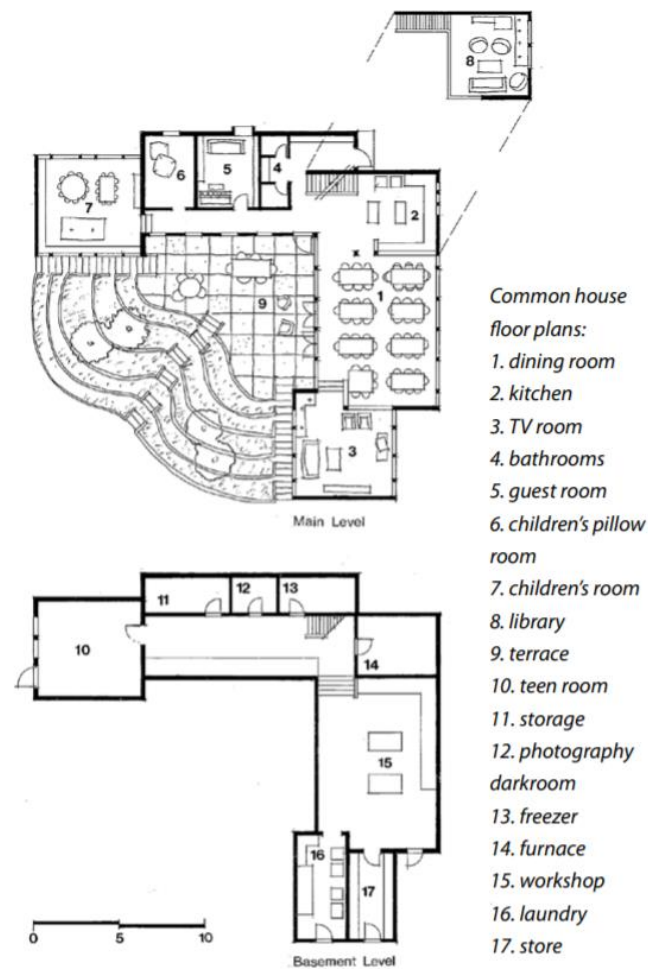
Diagrama da planta baixa da casa comum da comunidade Trudslund Chousing. Fonte: McCamant ; Durrett (2011)
